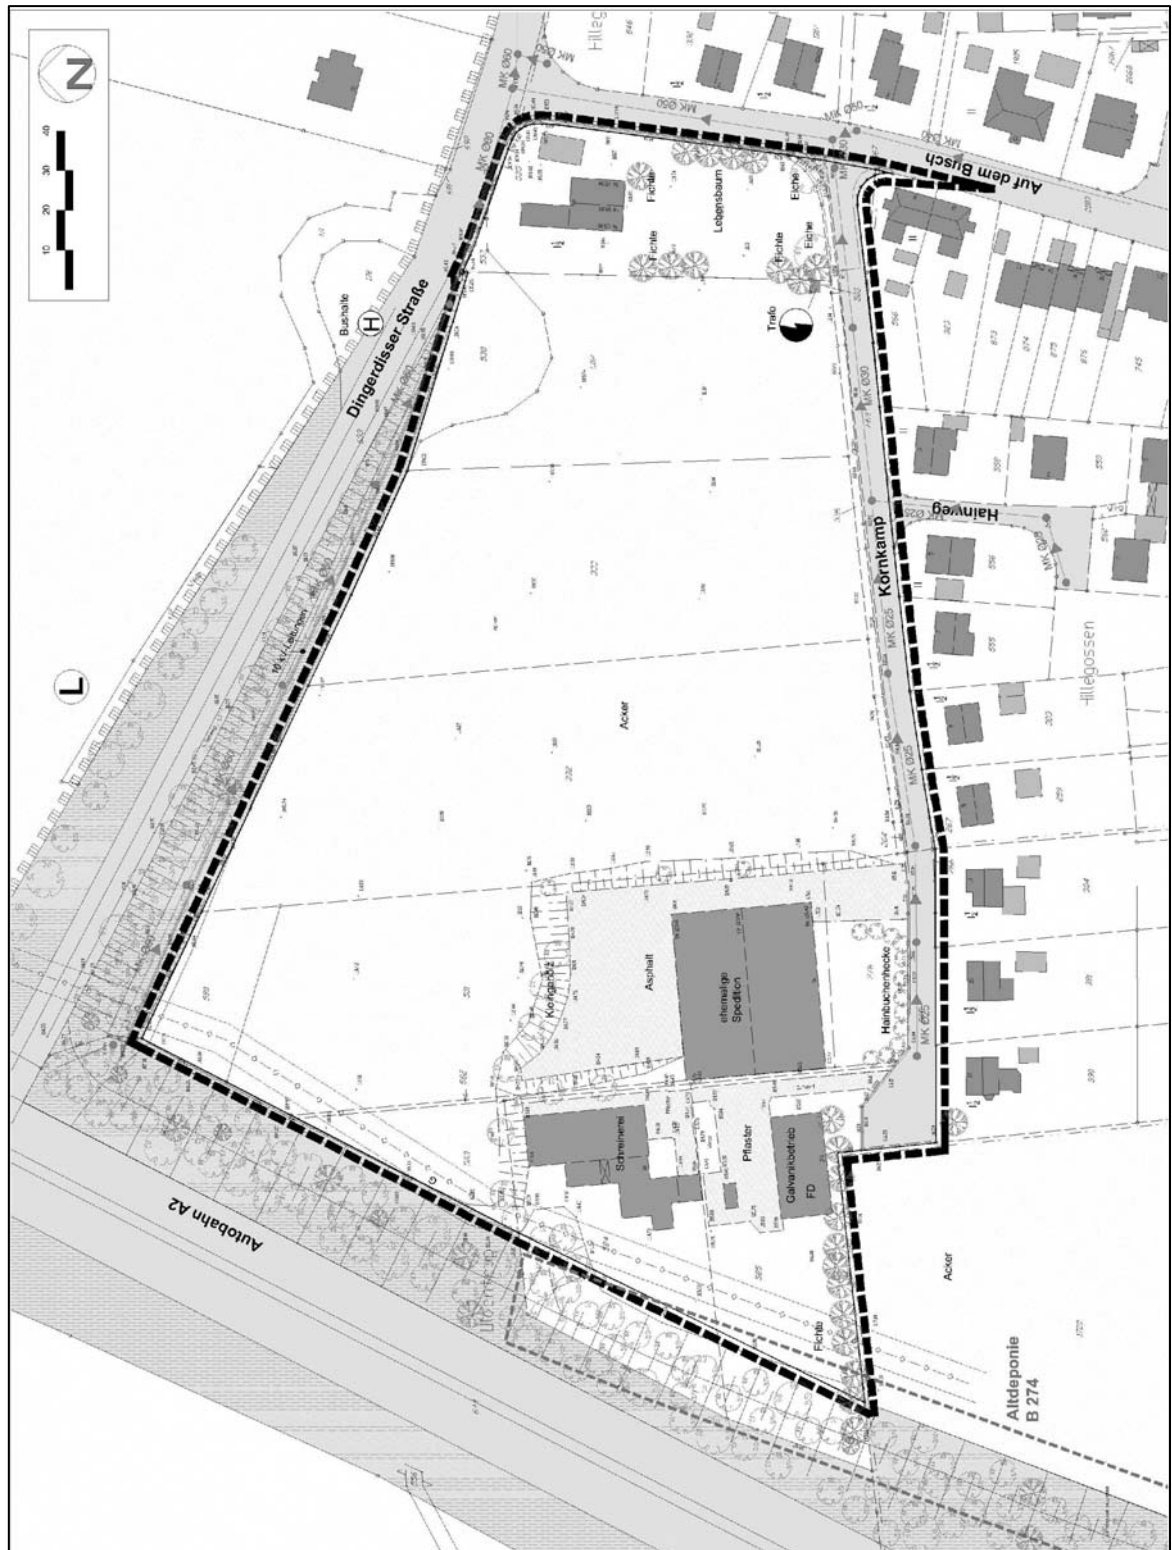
Bebauungsplan Nr. III/O 11, Bestandsplan
